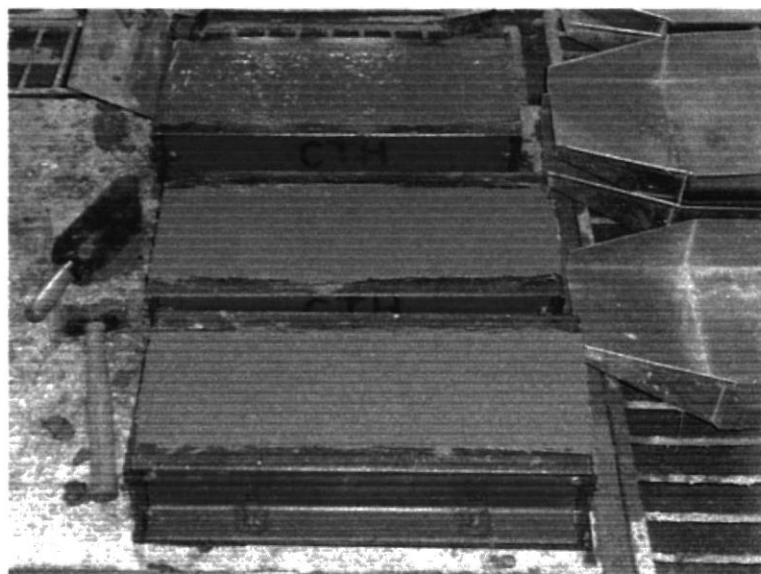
Llenado y Compactado de la primera capa de las vigas
